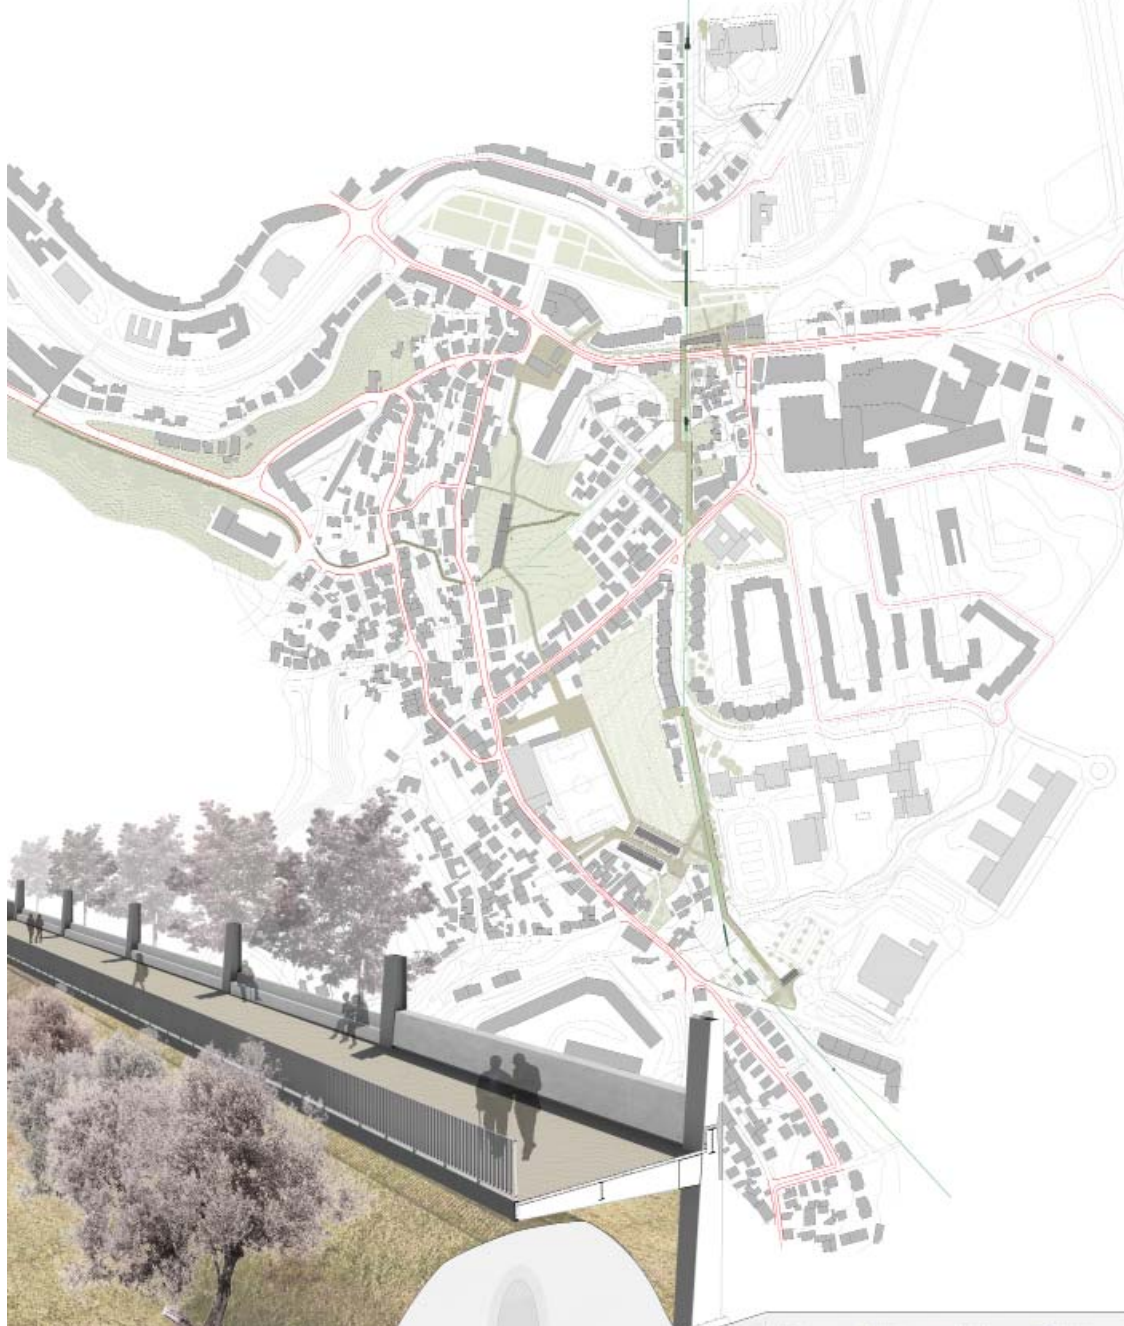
Edifício de ligação de cotas, no extremo norte do passadiço
